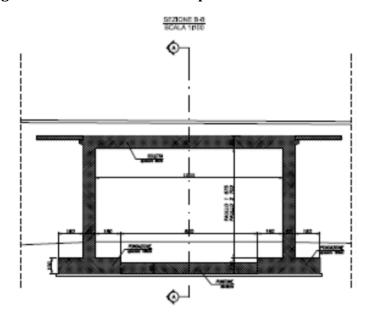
Sezione trasversale sottopasso Svincolo Paullo
